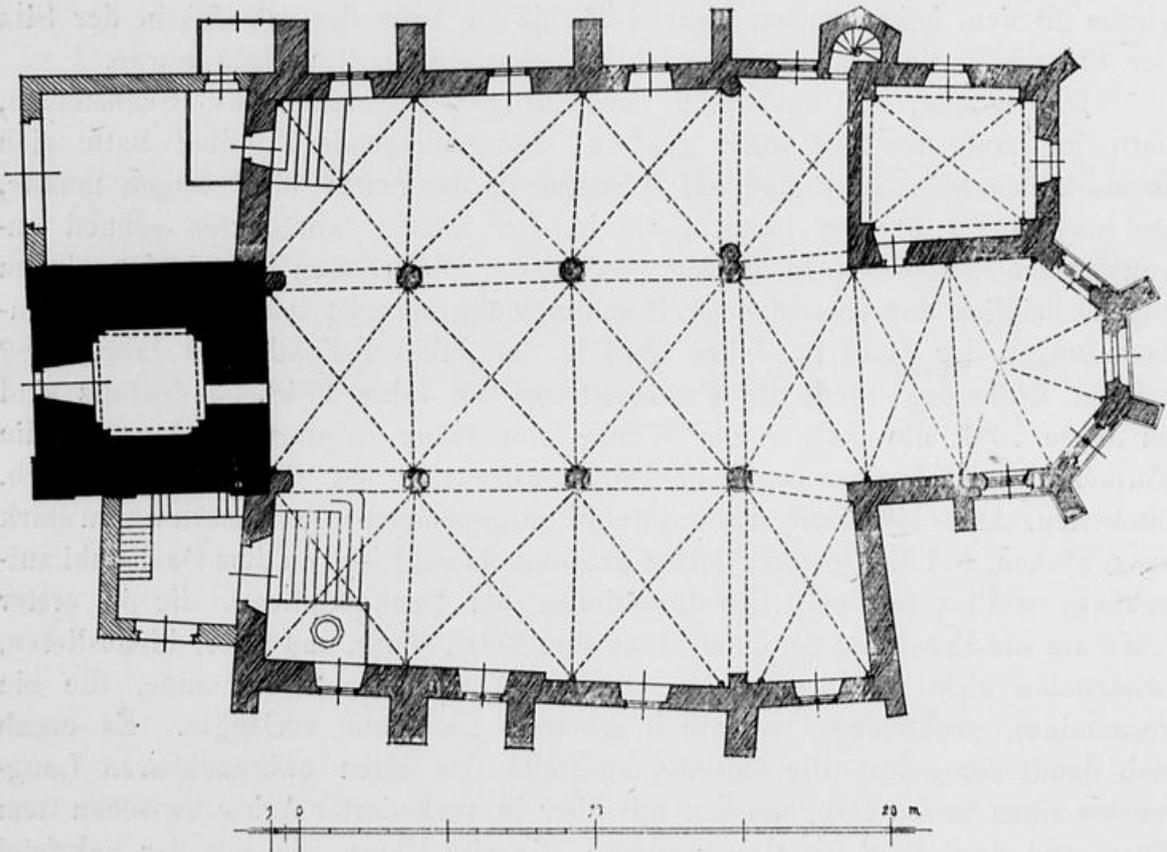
St. Vith. Grundriss der kath. Pfarrkirche vor der Erweiterung.
